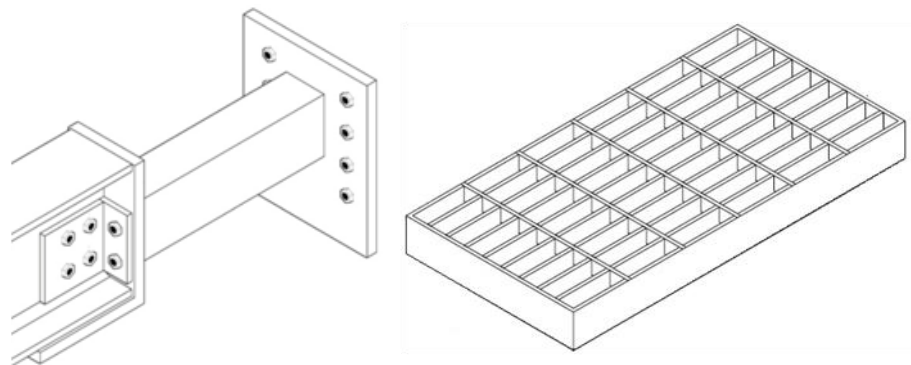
, Sistema di fissaggio trave IPE 120- muro perimetrale e griglia piano di calpestio. Fonte autore tesi
